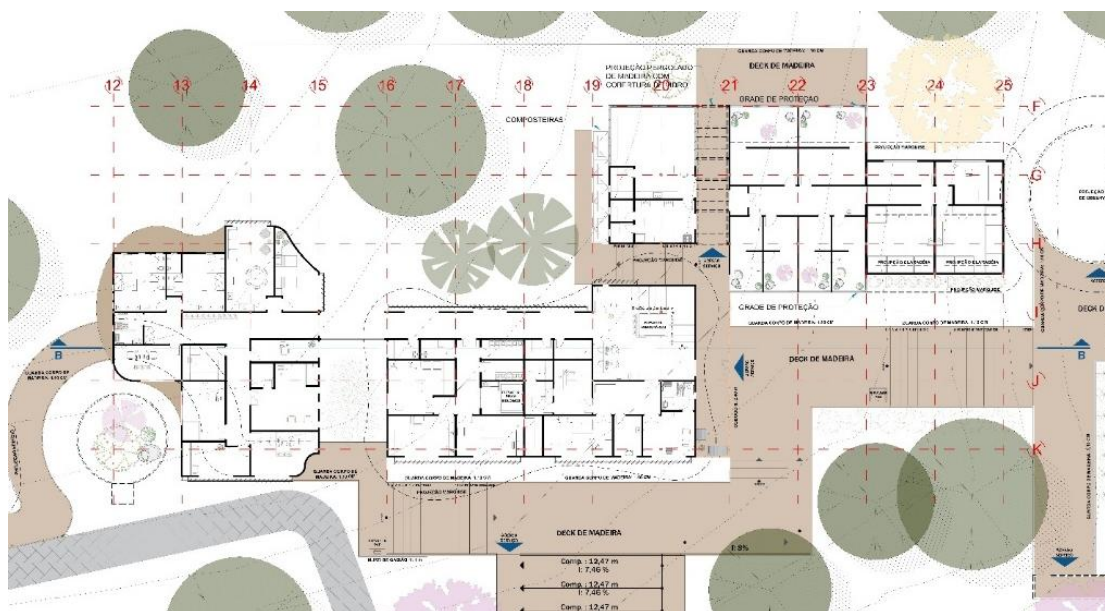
Planta baixa - segundo pavimento da área pública e expositiva.
